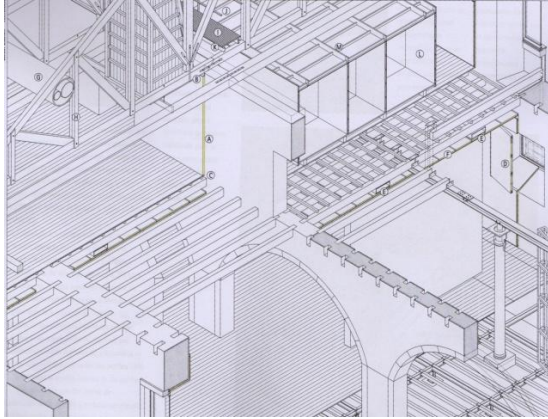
CAV-axonometria construtiva, pavimento do Piso1 [36]
